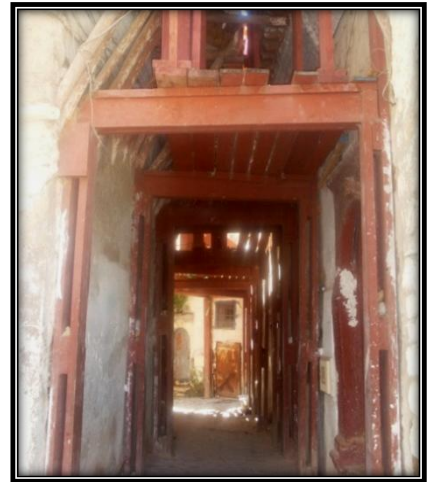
Renforcement des murs de la casbah par des supports en bois
